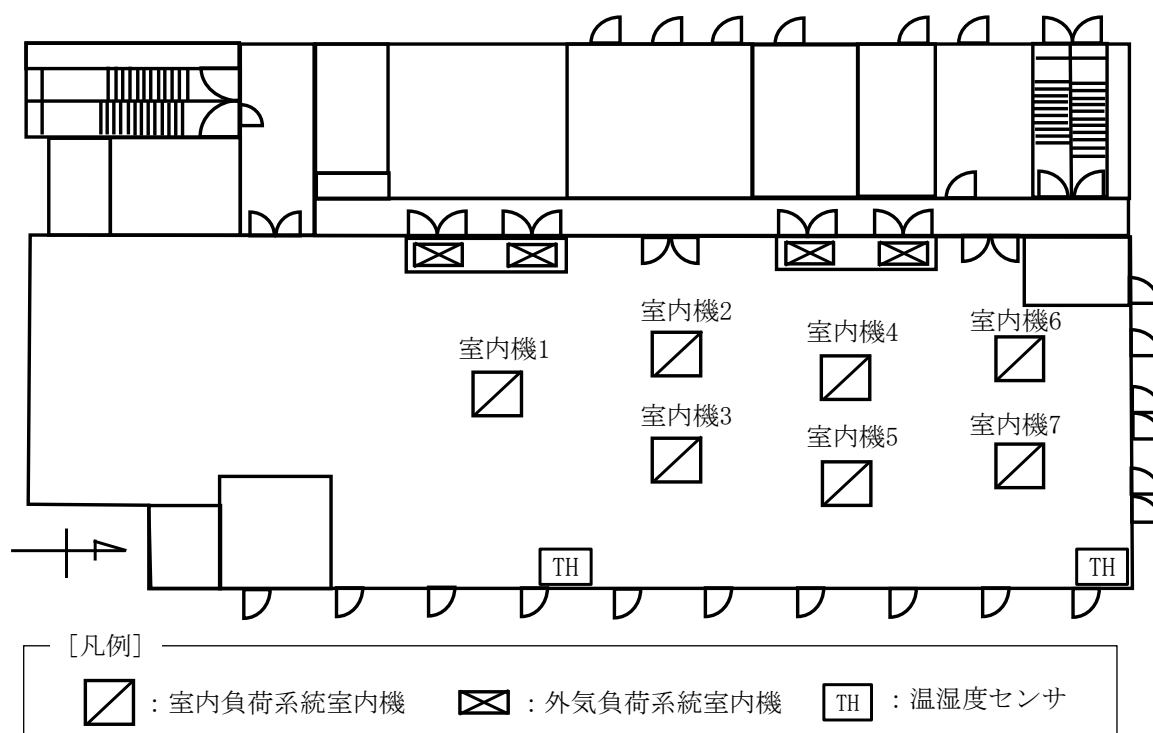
1F執務室の制御対象室内機・センサ配置図
